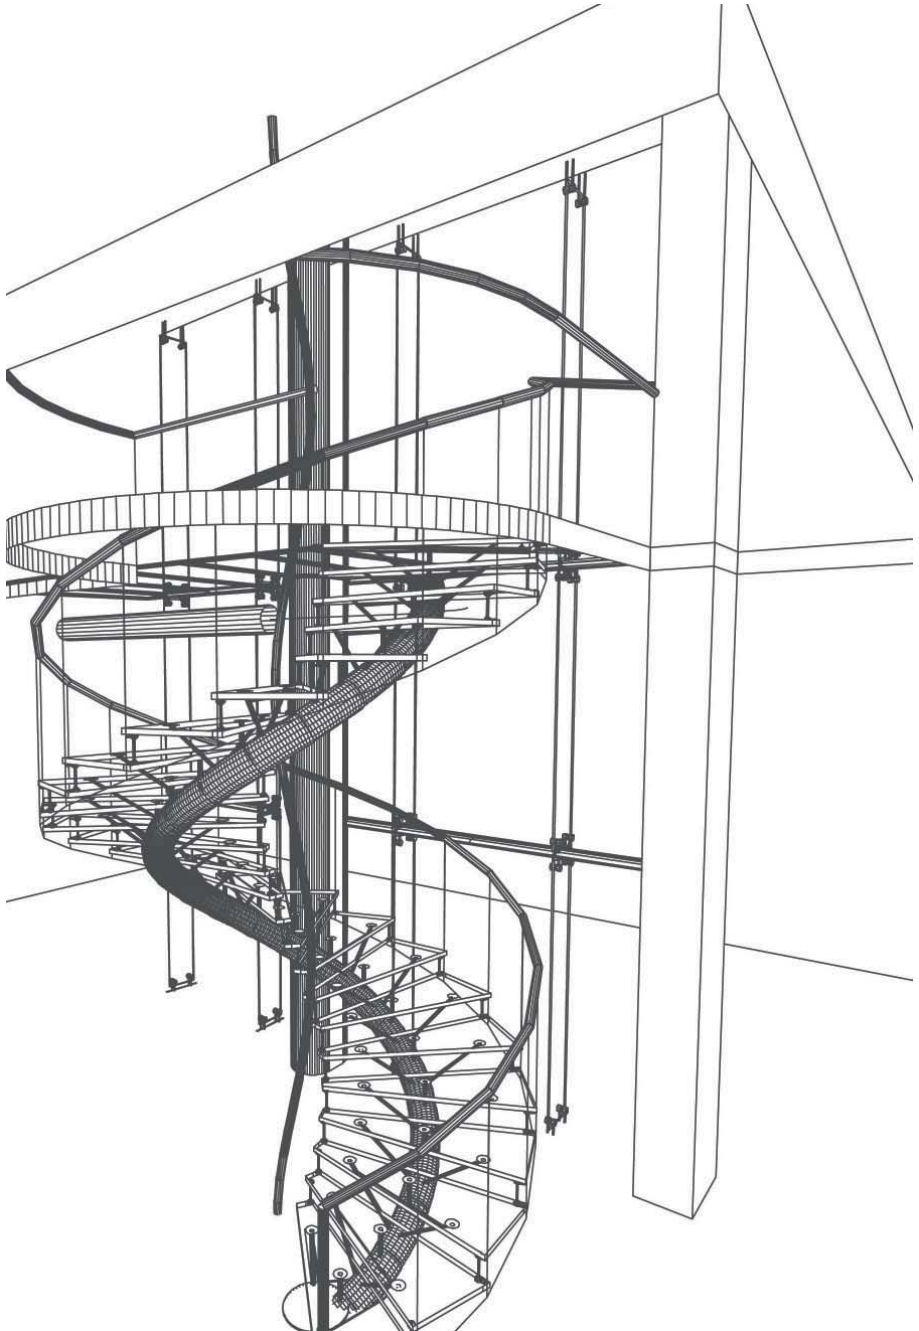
Ontwerptekening van een spiraalvormige wenteltrap met dragende glazen balustrade voor een villa voor de Koninklijke familie in Jeddah, [arch. Atelier One/architect Mick Eekhout] met dragende glas balustrade om de trap
